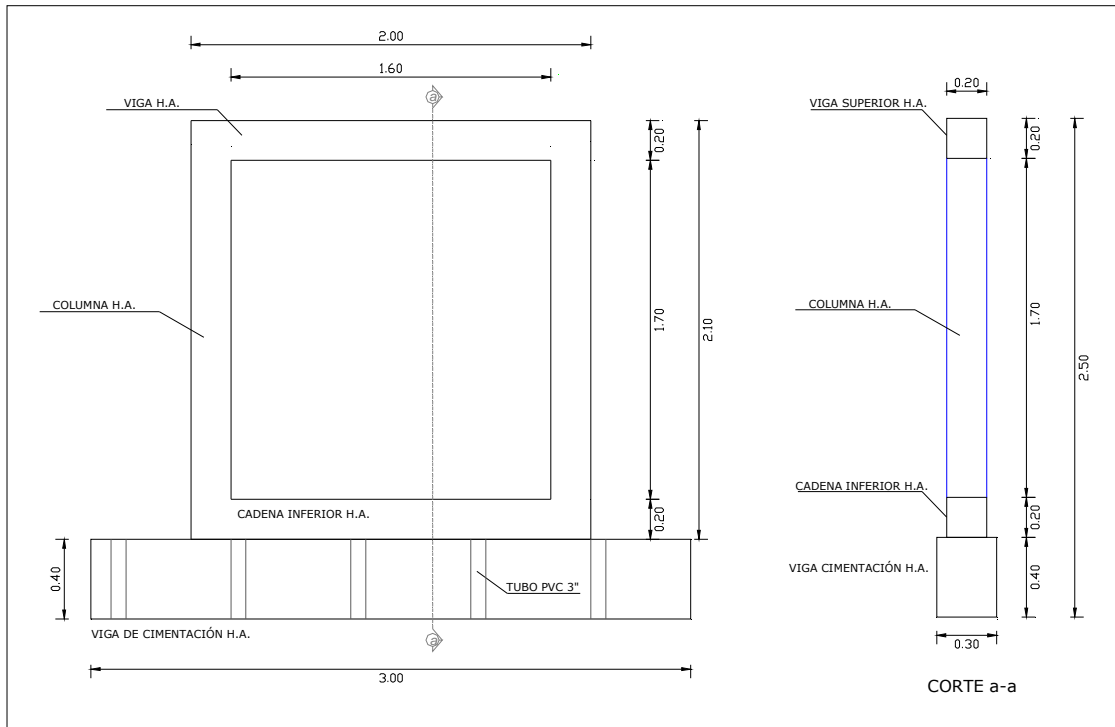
Geometría del Pórtico Tipo de H.A.
